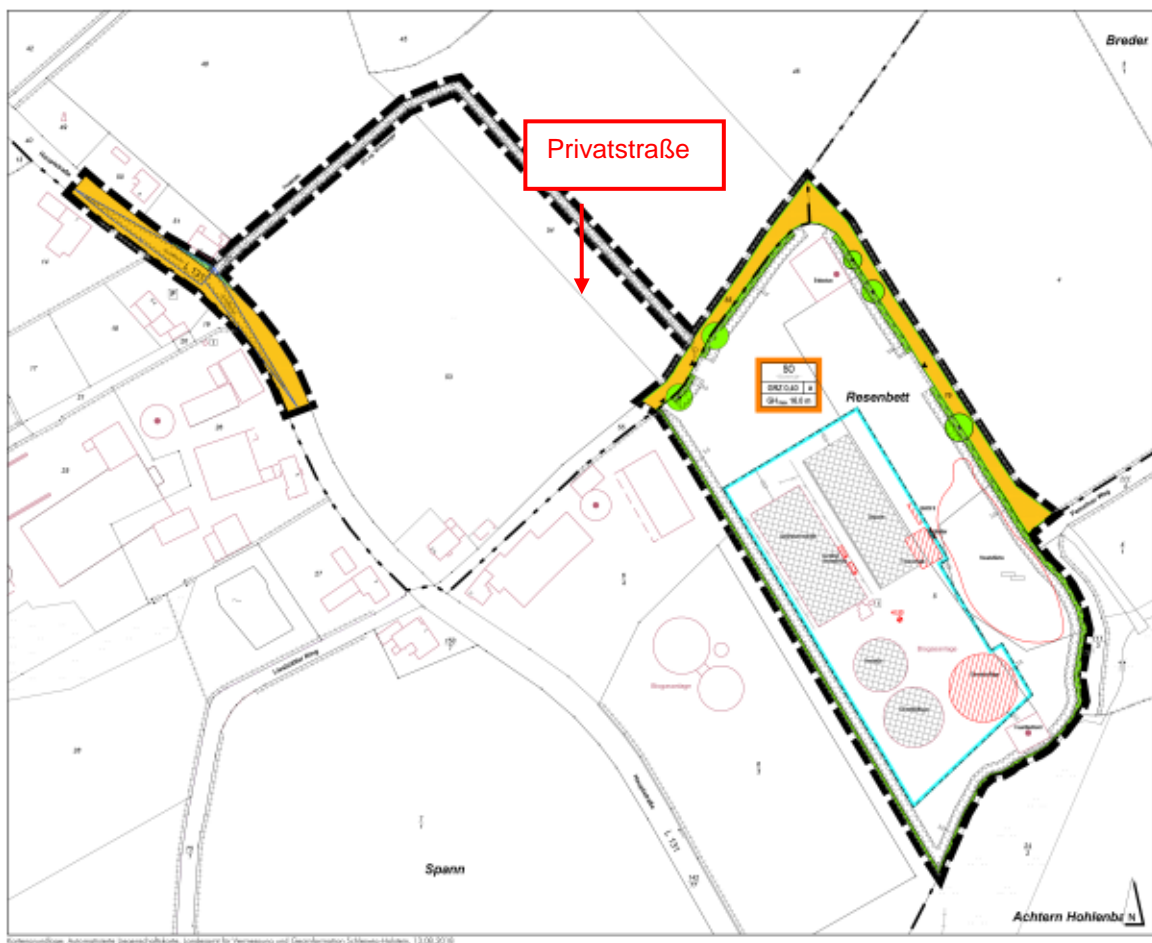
Auszug aus dem B-Plan mit Anlagengelände der Biogasanlage und Privatstraße
